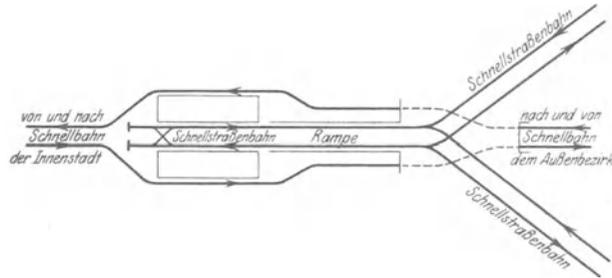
Anschlußbahnhof für den Übergang zwischen Schnellbahn und Schnellstraßenbahn, Parallelstation mit Richtungsbetrieb.
